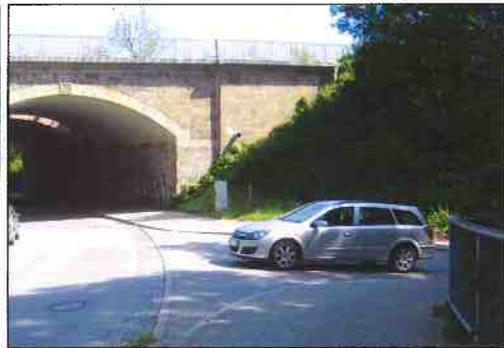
Zufahrtbeschränkung Brunnenstraße
